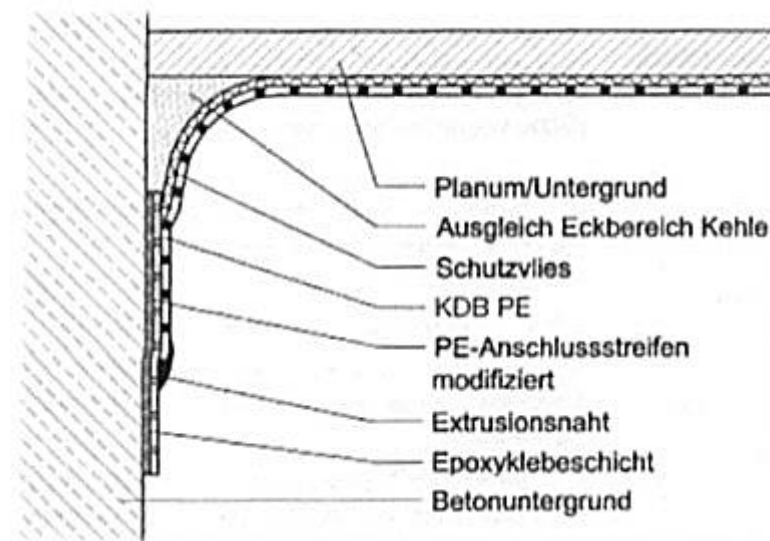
Anschluss einer KDB an ein bestehendes Betonbauwerk mittels eines Klebestreifens⁵¹
